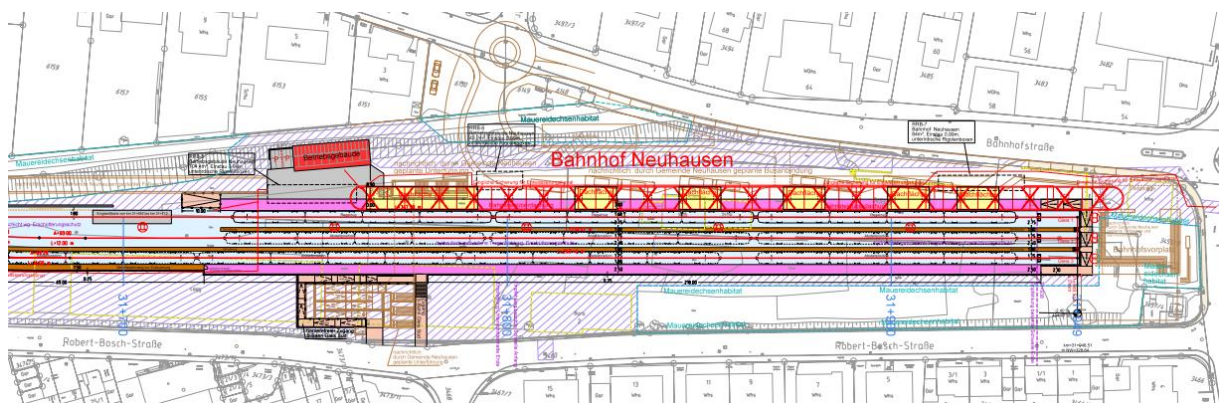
S-Bahn Stuttgart, S2-Verlängerung Filderstadt – Neuhausen a. d. F., Auszug aus den Planfeststellungsunterlagen, Anlage 5.8 neu, Stuttgarter Straßenbahn AG, Stuttgart, gepr19.03.2021
